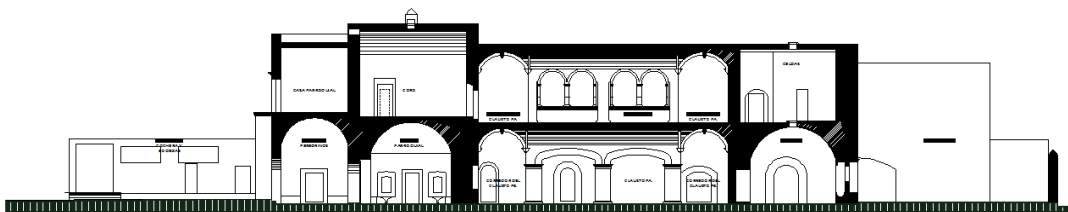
Corte transversal. Se aprecian bóvedas de cañón corrido en ambas plantas del edificio.
